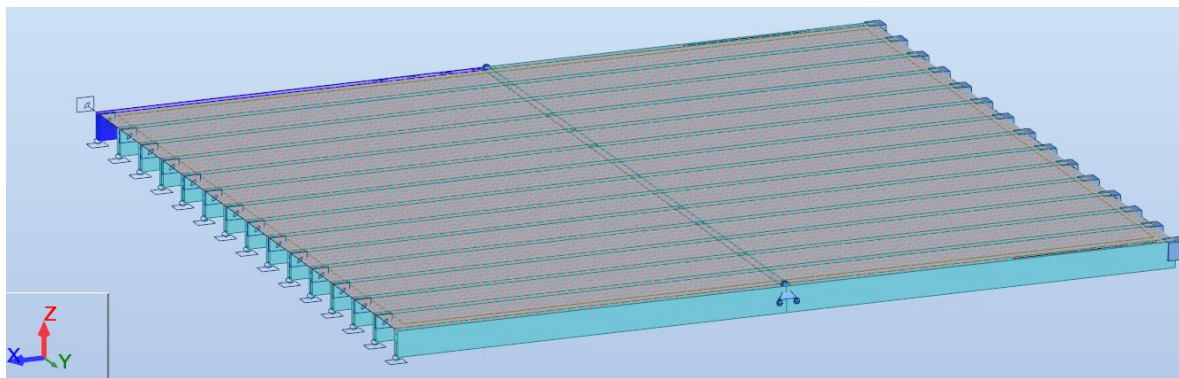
Modelo numérico do pavimento PVC_1
